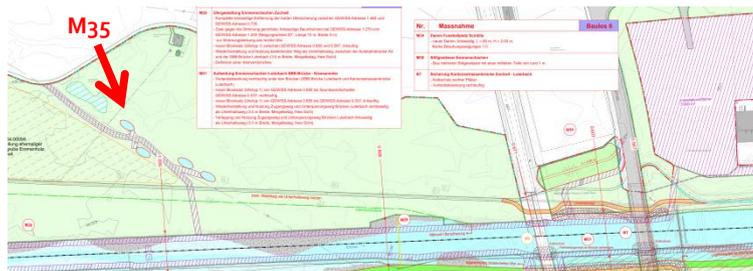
Ausschnitt aus Teilstrecke 5 (Planbeilage 2.10)
